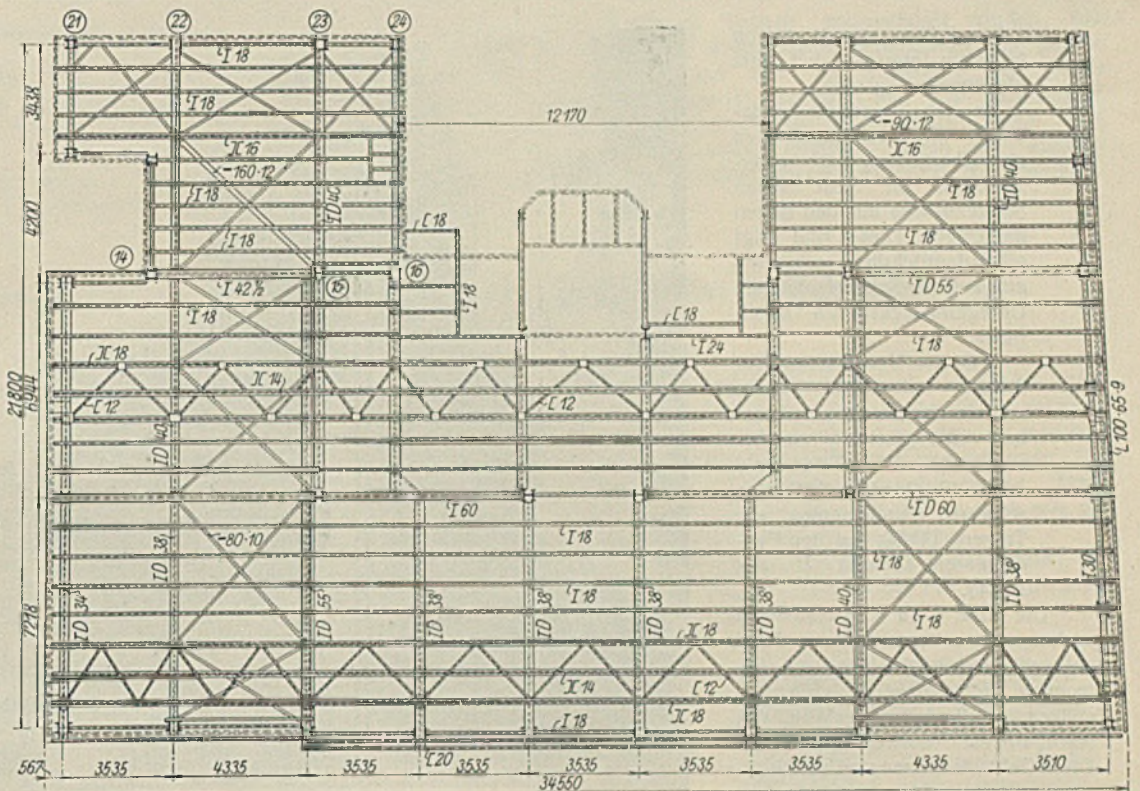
Grundriß der Decke über dem 6. Obergeschoß mit Windverbandsanordnung.
